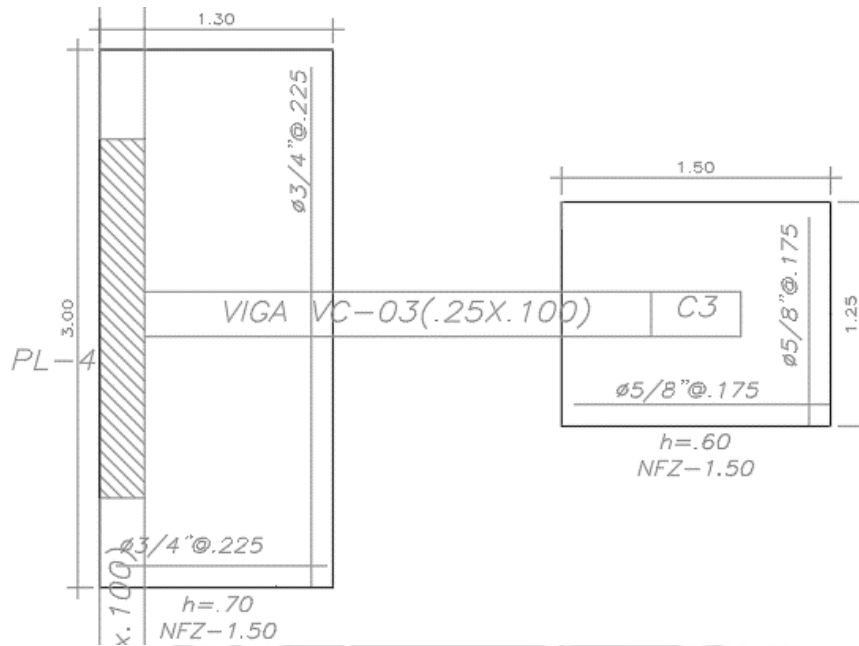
Refuerzo de las zapatas conectada de PI4 y C3
